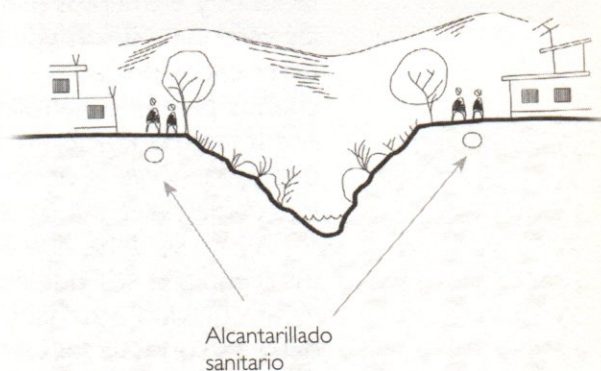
Escurrimiento pluvial principal protegido con alcantarillado o calles paralelas.
